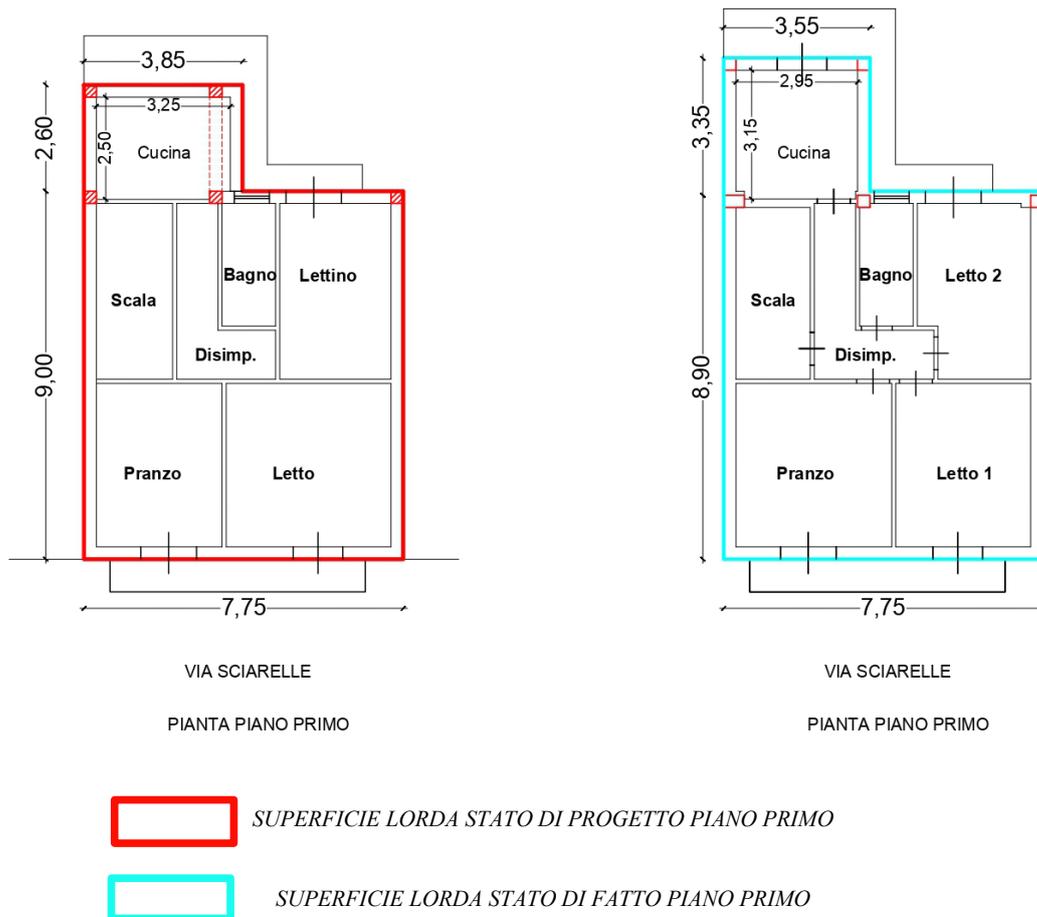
Rappresentazione della sopraelevazione del primo piano come da progetto e come da rilievo
